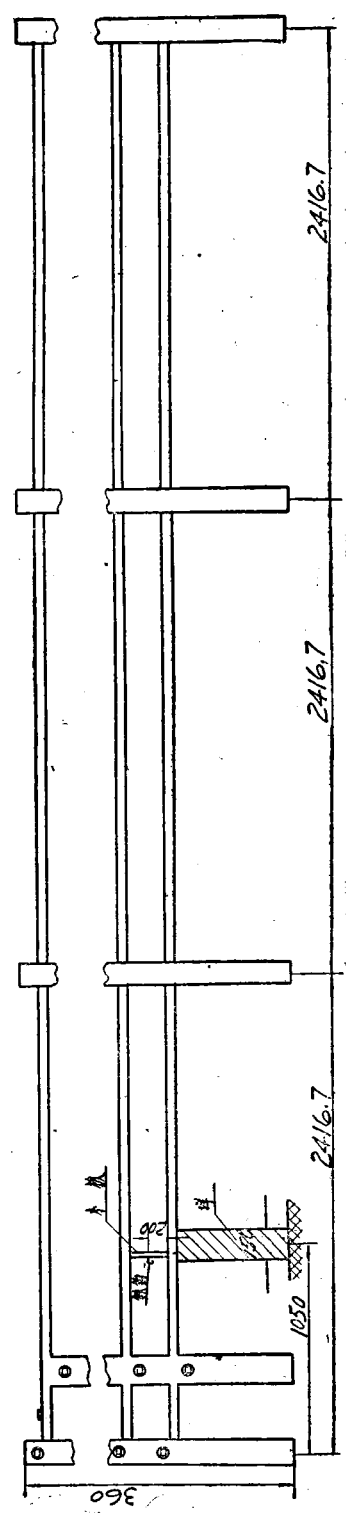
祁門加溫姜湯室平面图 (单位: 公厘)
